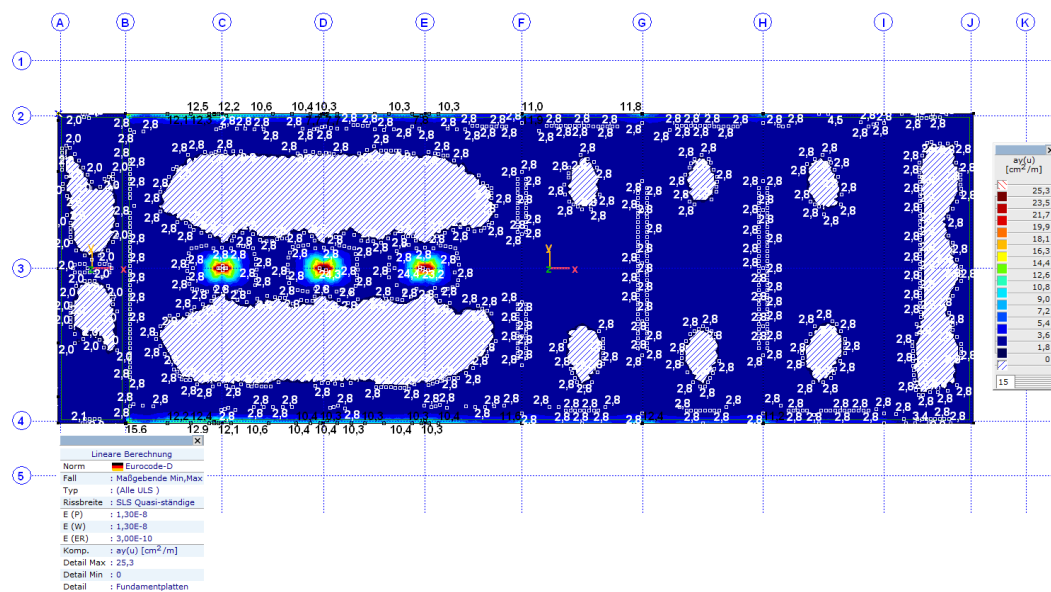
Berechnete untere Bewehrung in lokaler y-Richtung ay(u)
